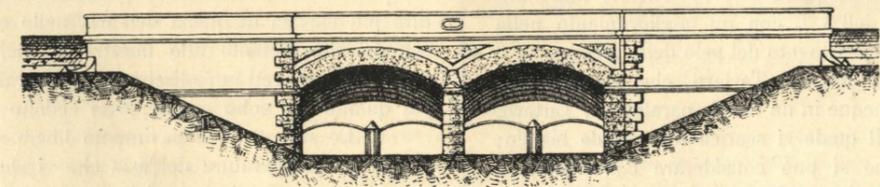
Prospetto normalmente all'asse del Canale Maestro.
